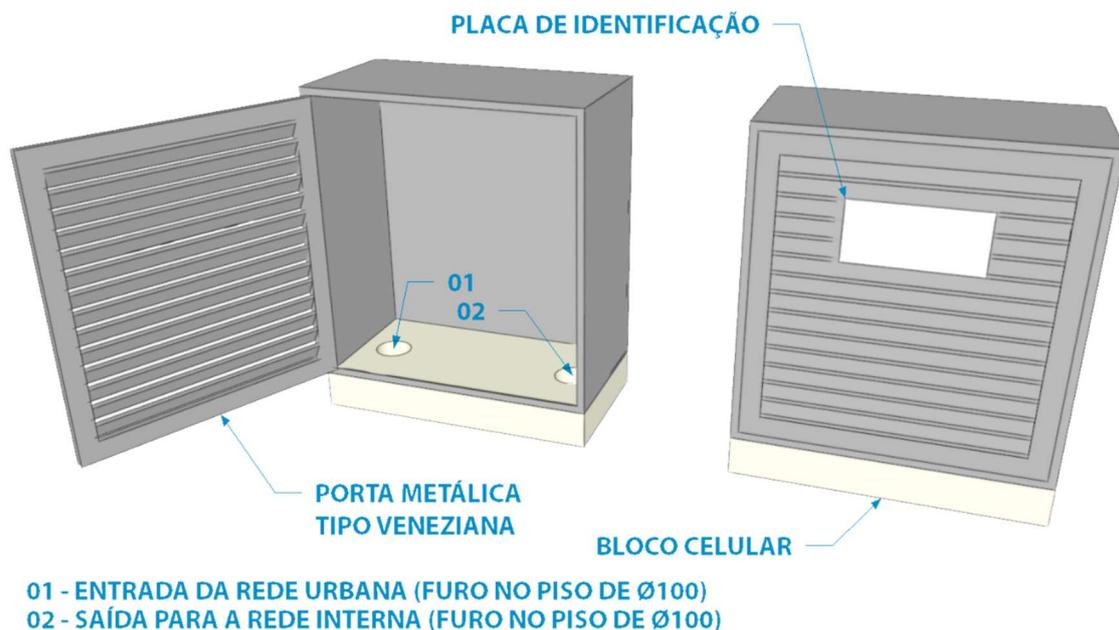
Modelo ERU civil em alvenaria ou concreto pré-moldado
